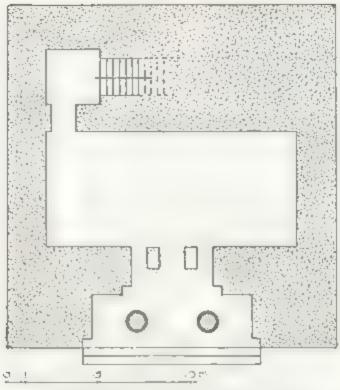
Karkemisch, Grundriss des Hilani.
